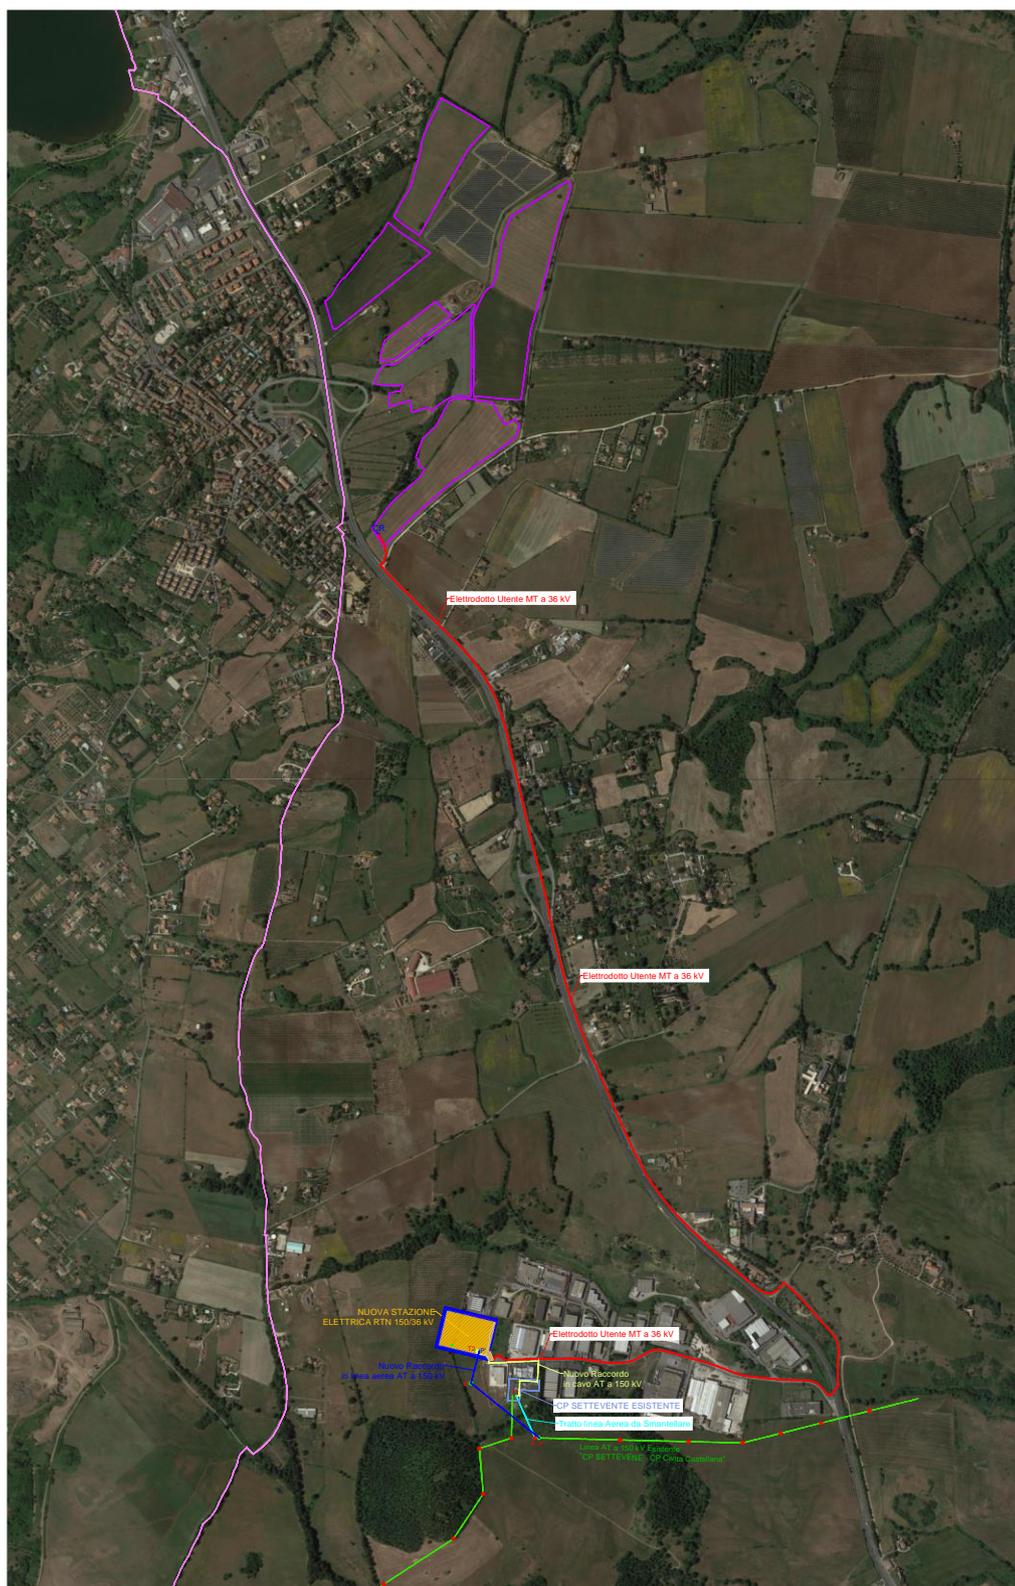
Planimetria dell’Impianto e delle Opere di Impianto per la Connessione
